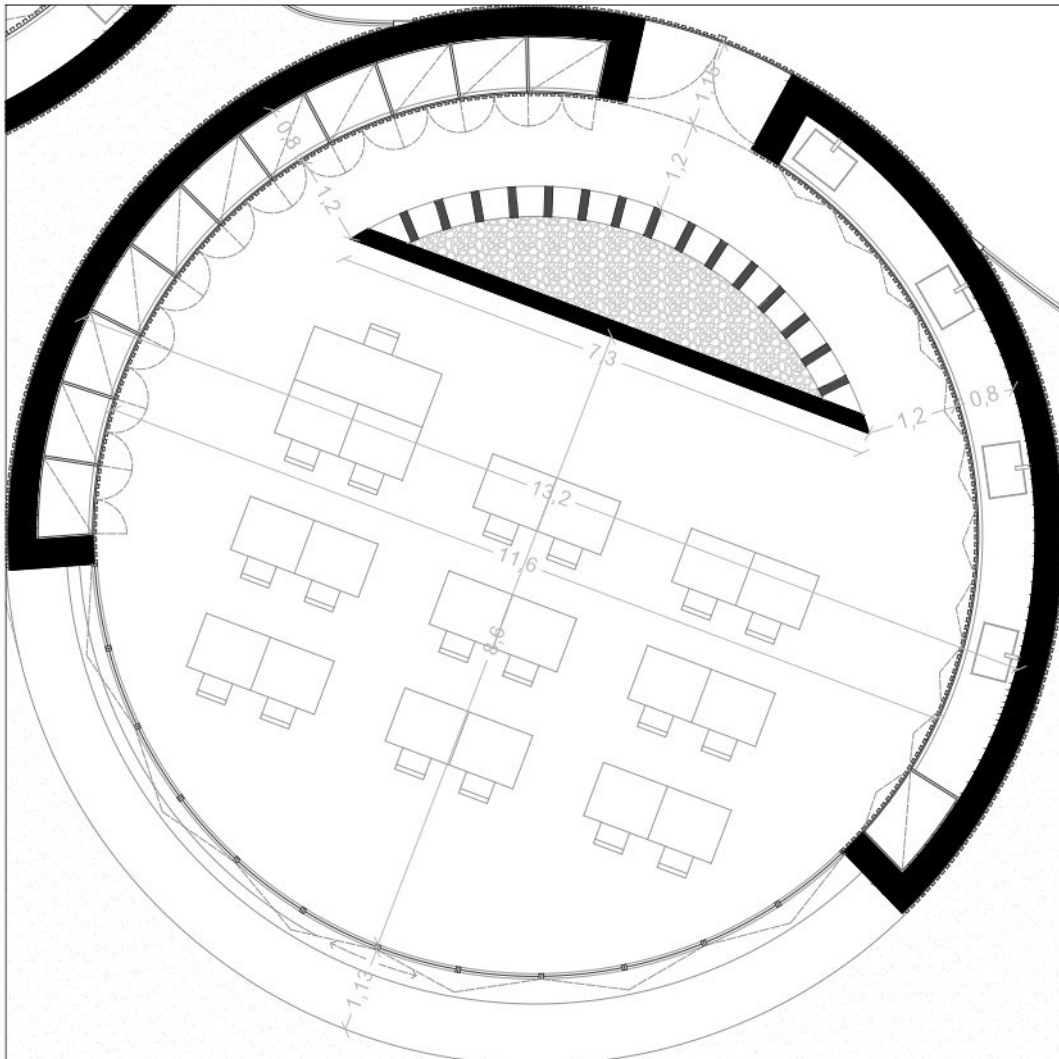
Planta do Laboratório, do Tipo 2, à Escala 1/100
